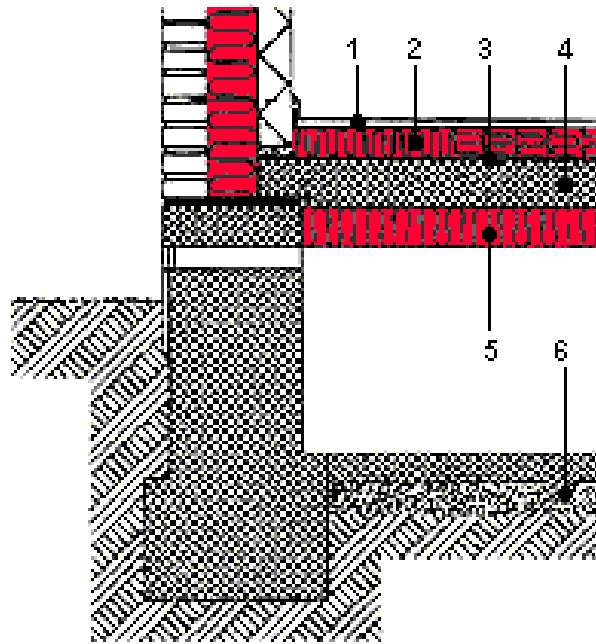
Теплоізоляція низького підвалу з бетону або легкого бетону (ROCKWOOL):
